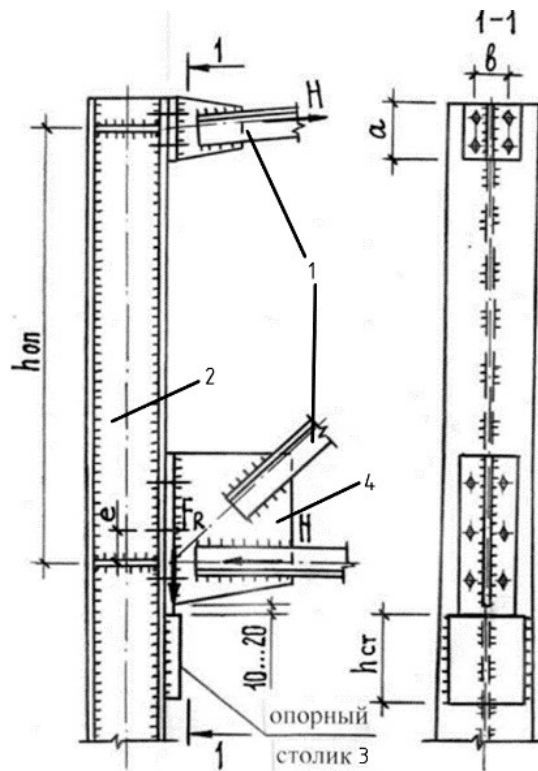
Узел опирания фермы на колонну сбоку:
